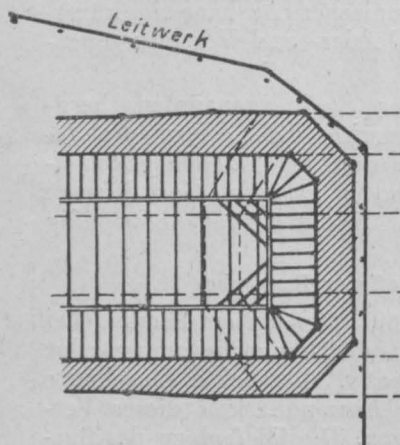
Grundriß der Baugrube (Spreetunnel, Berlin).
